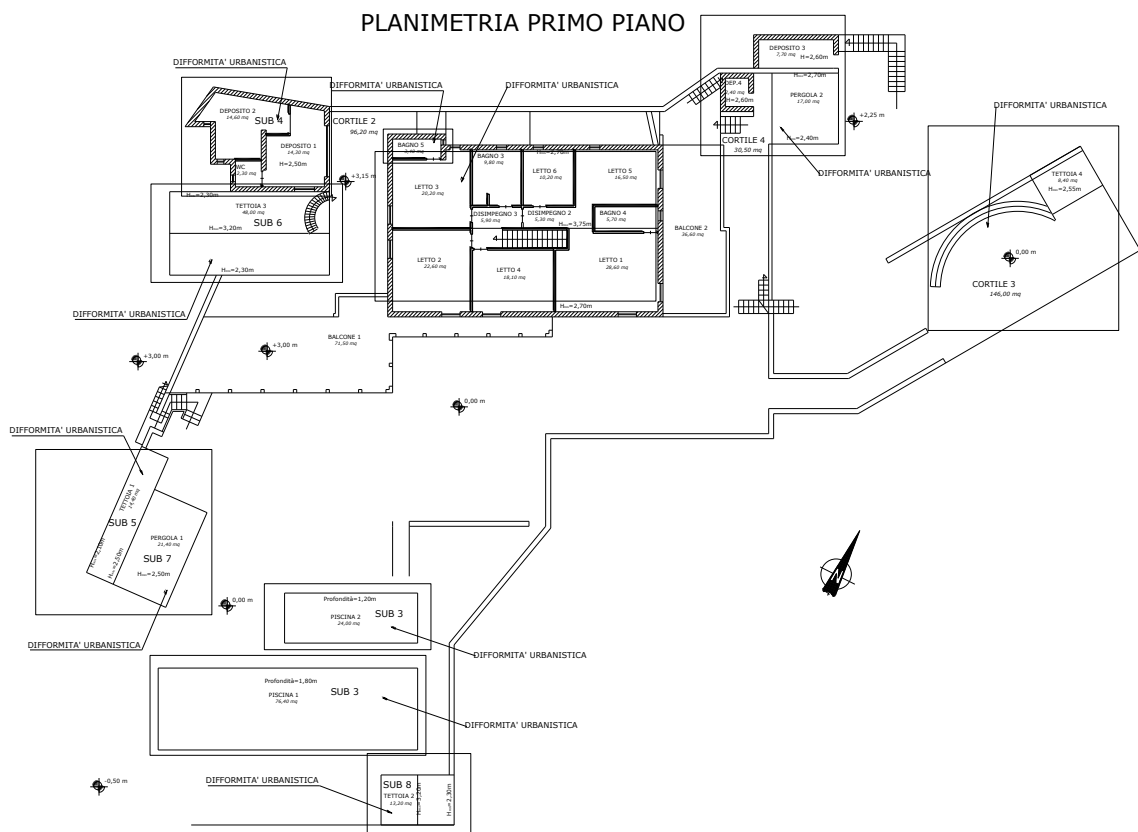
planimetria delle difformità urbanistiche del primo piano della villa
